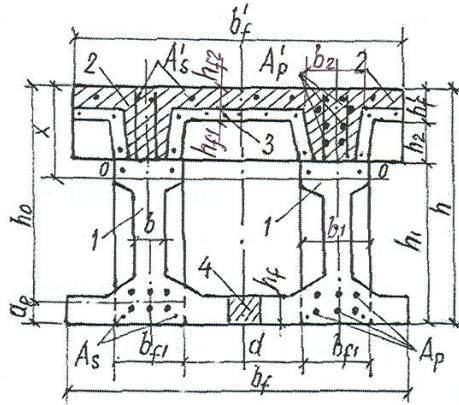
Поперечний переріз збірно-монолітних залізобетонних елементів із збірних балок двотаврової форми і ребристих плит, об'єднаних монолітним бетоном, що утворюють переріз коробчастої форми
